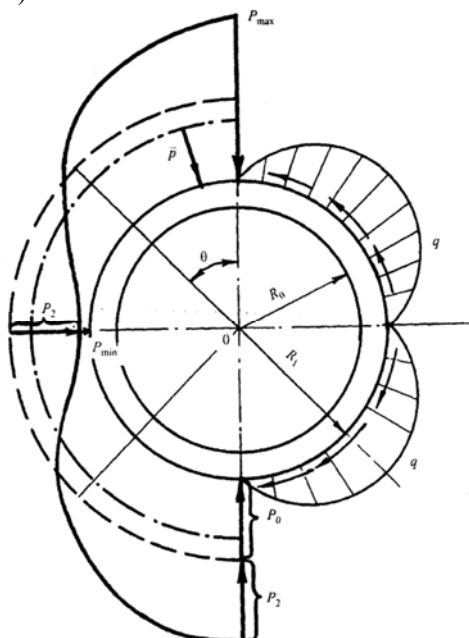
Схема передачи нагрузок на крепь вертикальной выработки: P_{max} – максимальная нагрузка; P_{min} – минимальная нагрузка; \bar{p} – средняя нагрузка; P_0 – равномерная часть нагрузки (средняя нагрузка); P_2 – неравномерная часть нагрузки
